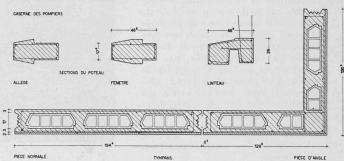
Détail des pièces préfabriquées (ossature et mur plein). Echelle 1:40.
